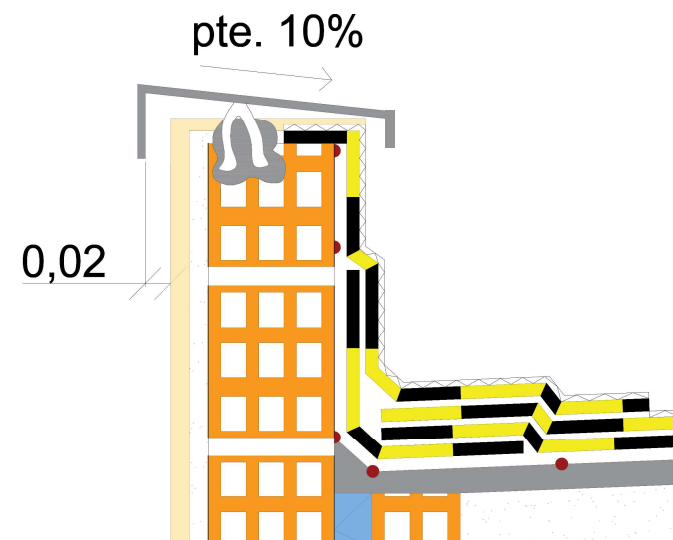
Detalle constructivo disposición albardilla metálica. Fuente: Elaboración propia.
